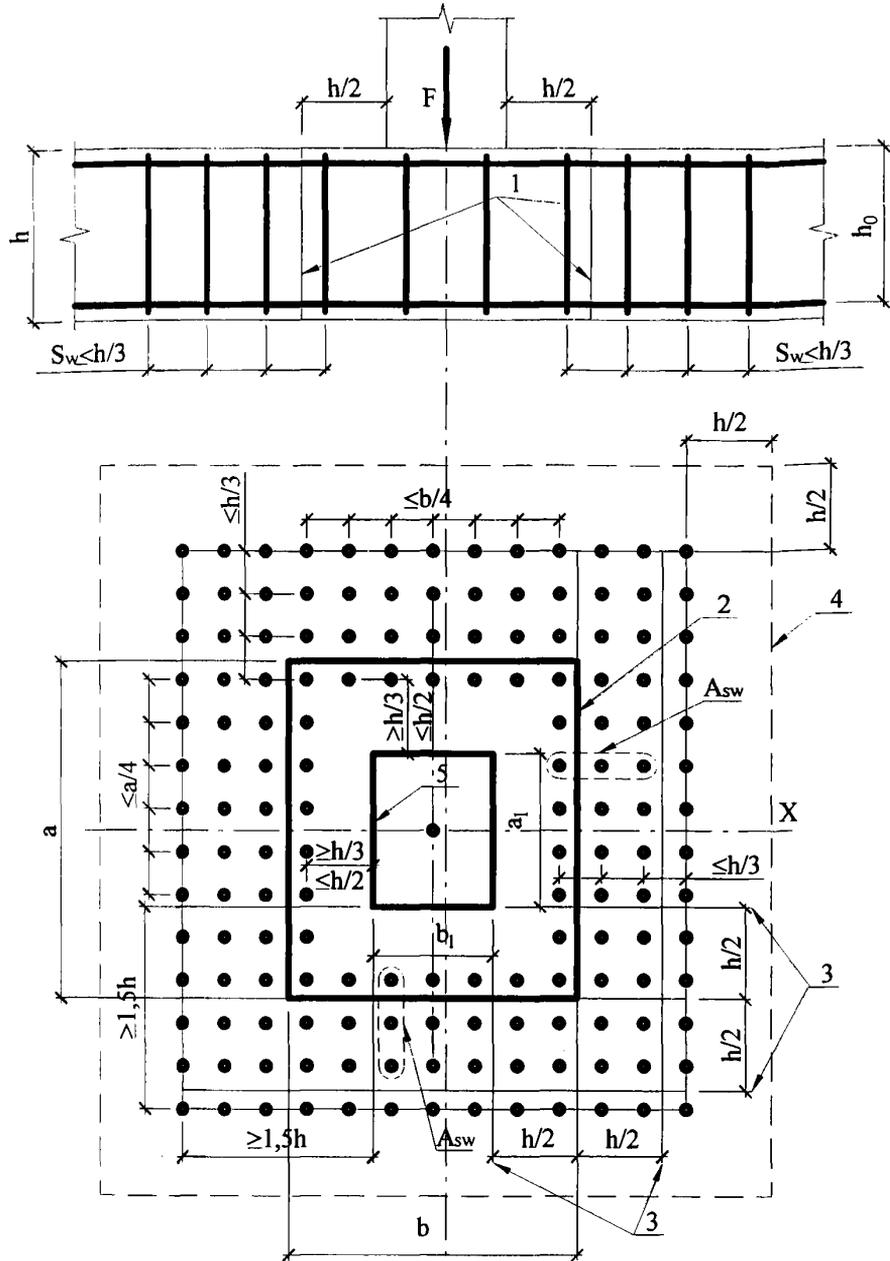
Схема для расчета сталефибробетонных плит с вертикальной равномерно распределенной поперечной арматурой на продавливание:
